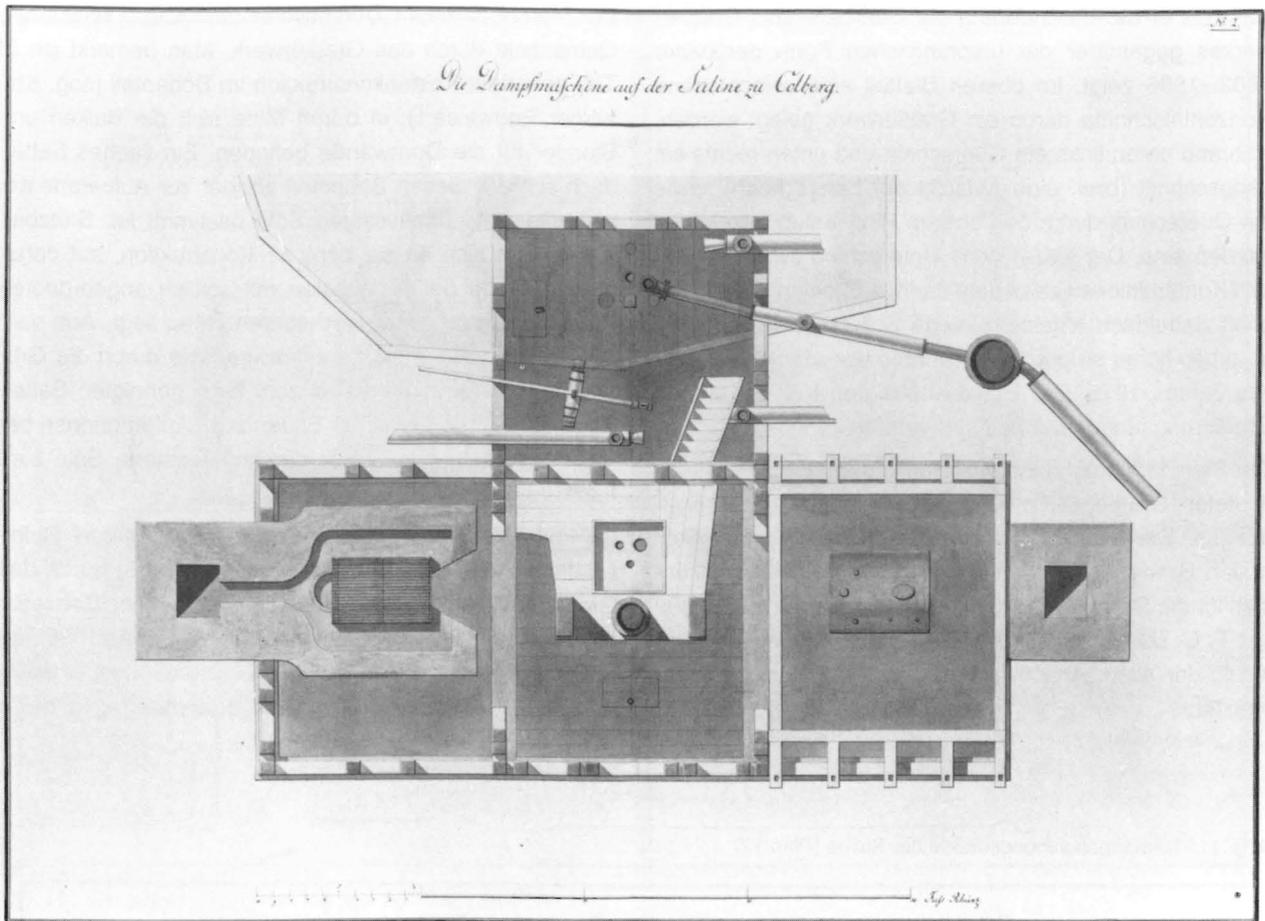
Horizontalschnitt durch das Dampfmaschinengebäude (Plan 13)
